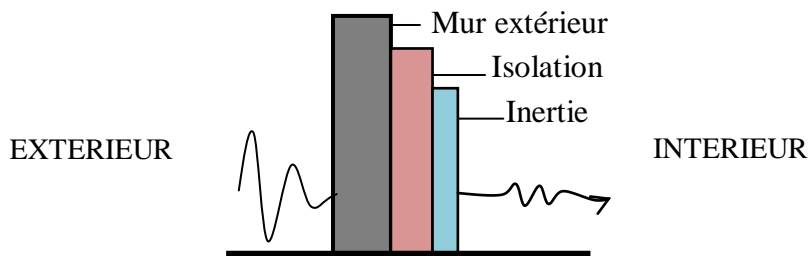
LES DIFFRENTS COUCHES D'UNE FACADE ISOLEE
